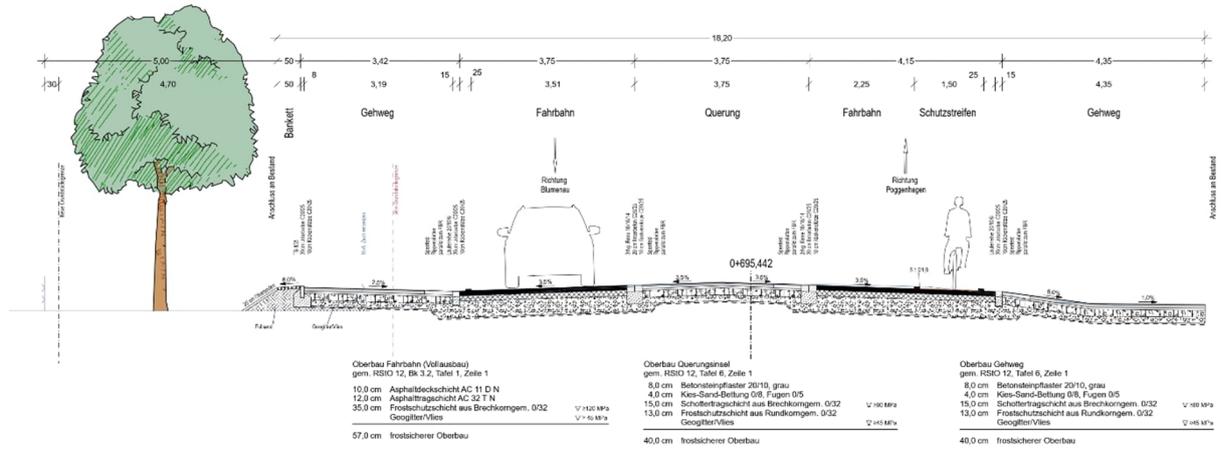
Ausbauquerschnitt – Querungsstelle Ortsausgang, Dachprofil
